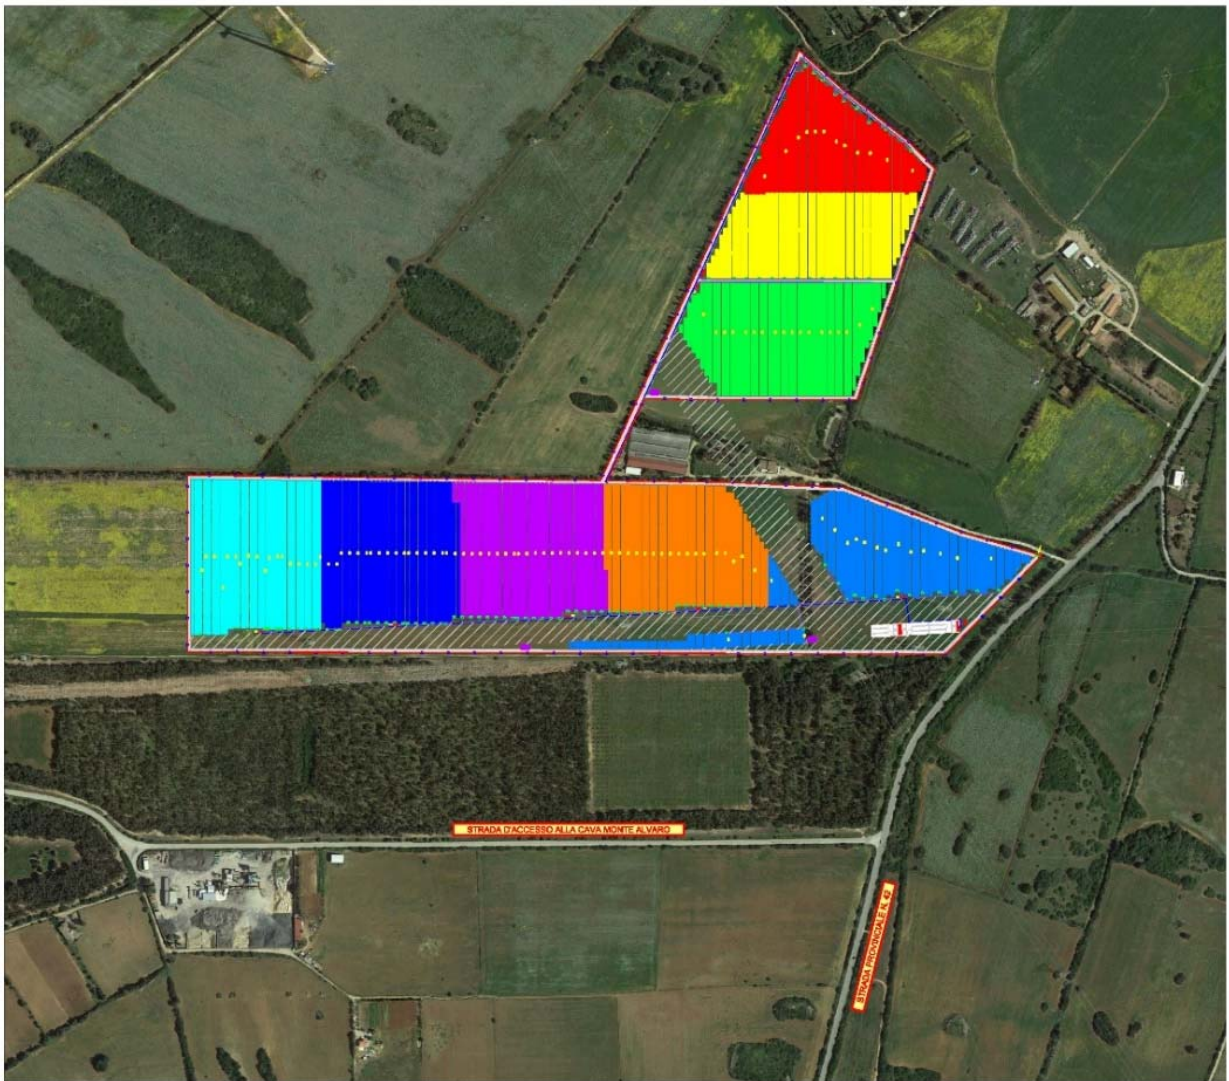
Planimetria dell'impianto fotovoltaico in progetto
